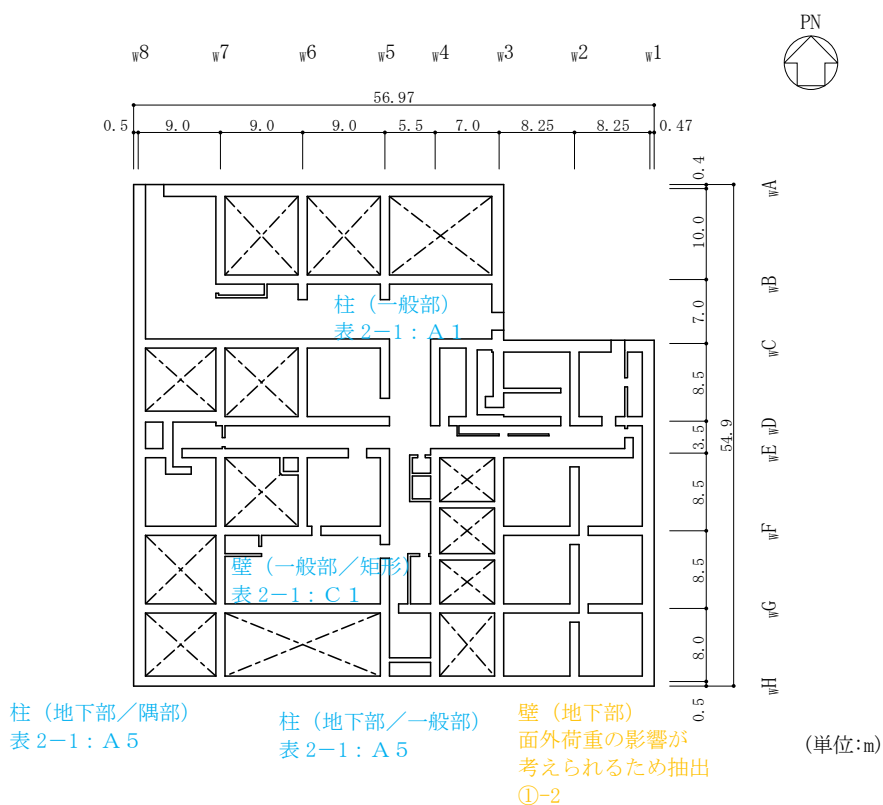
(2) 廃棄物処理建物の概略平面図 (EL 8.8m)
